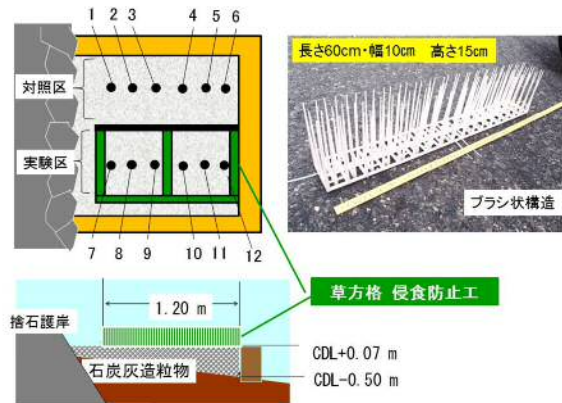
現地実証実験の平面配置図、断面図及び防止工仕様
